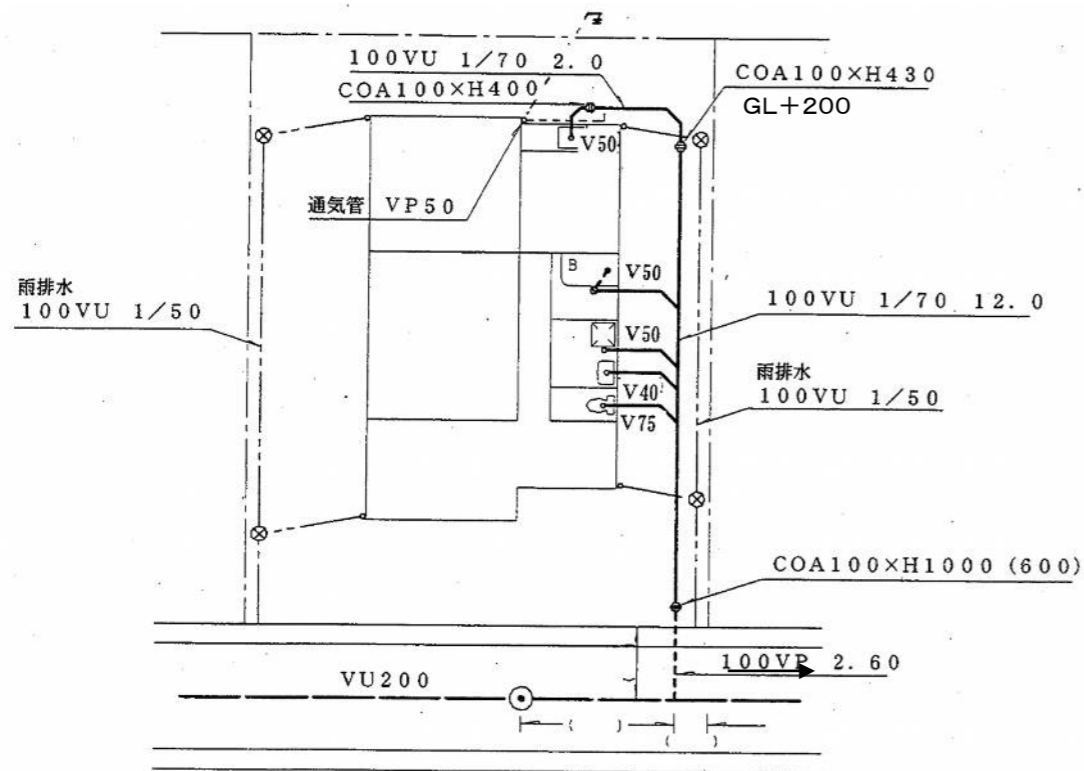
排水設備標準図 (例 1) 平面図縮尺 1/200
